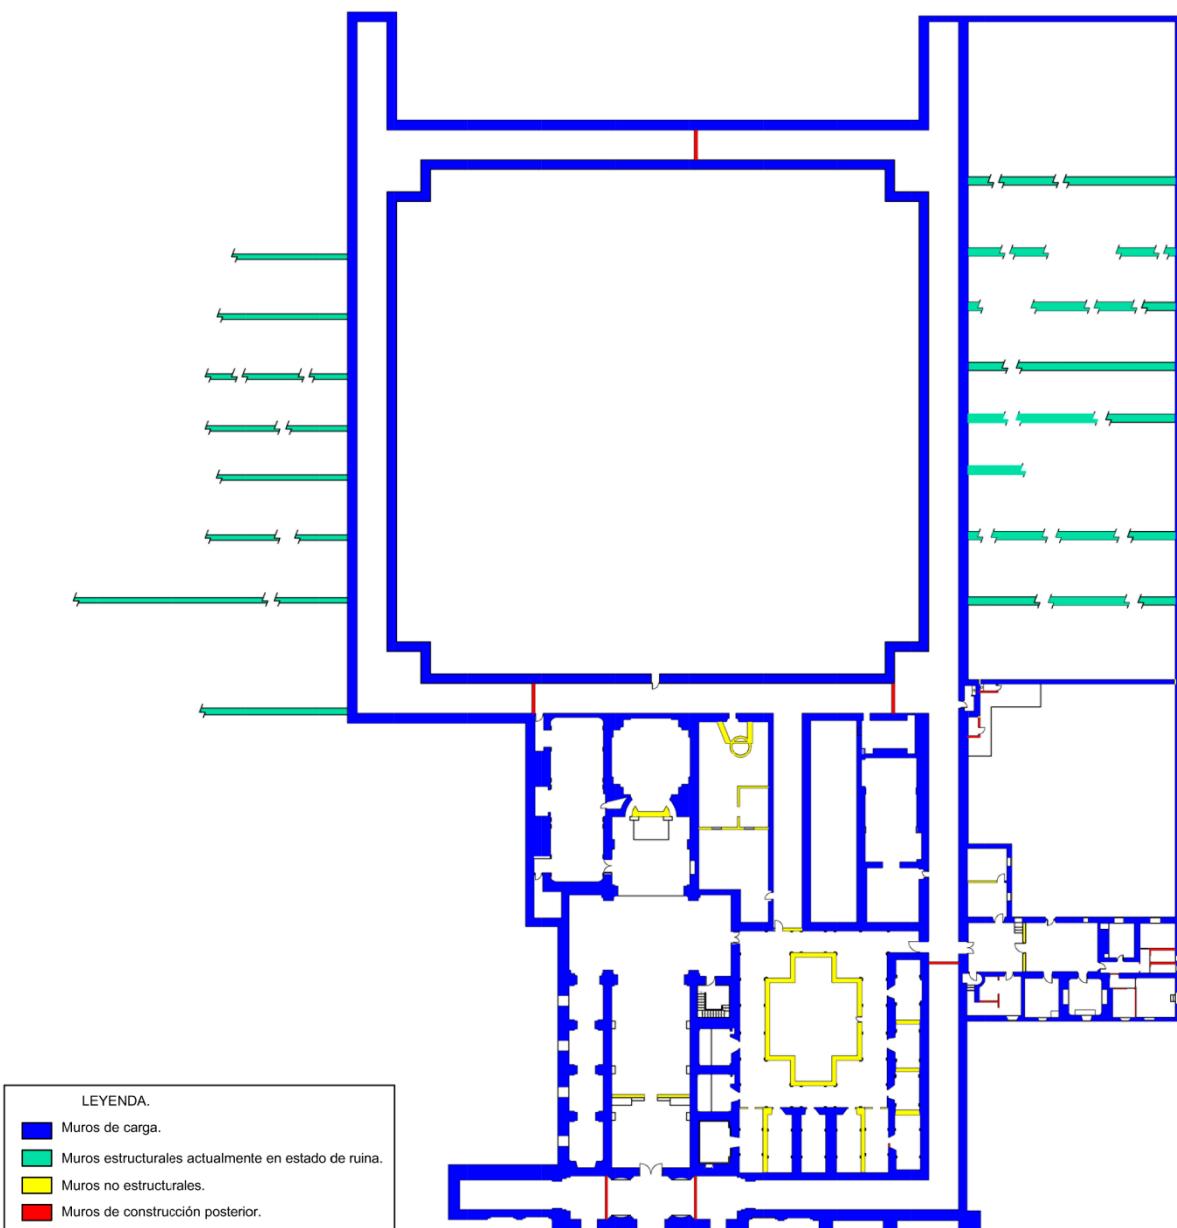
Plano general de la tipología de muros de la Cartuja.
